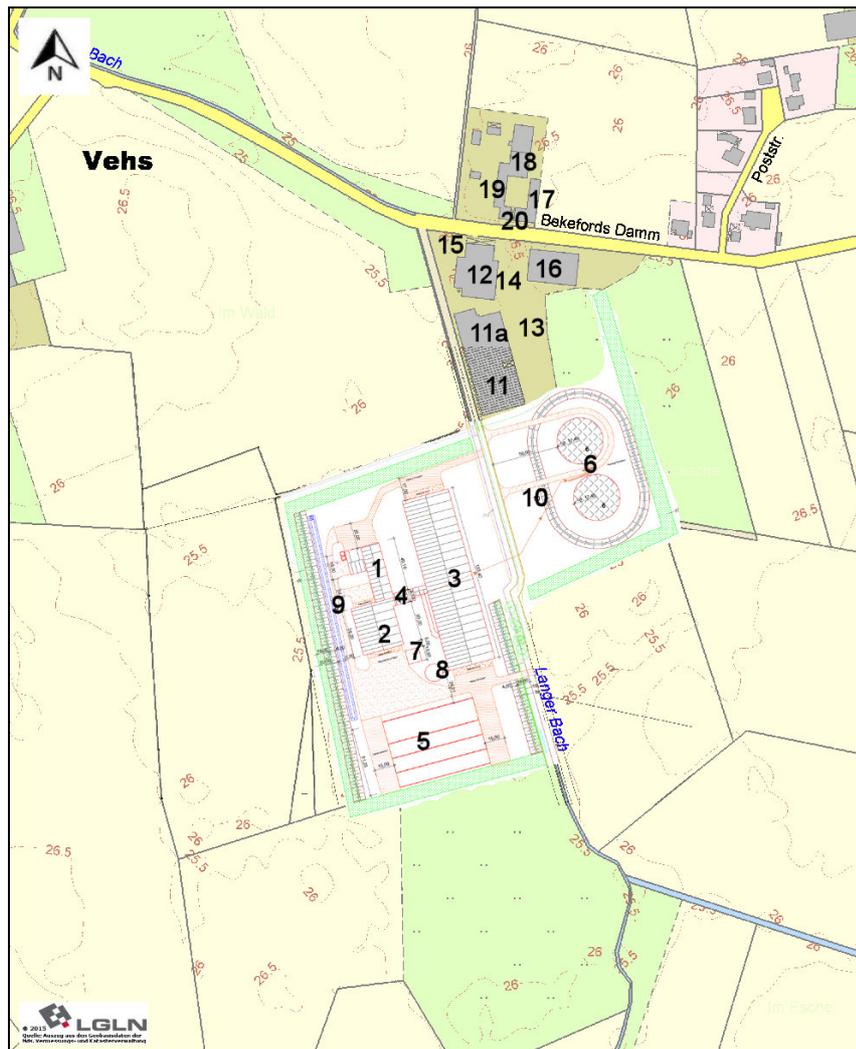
Lageplan des Betriebes Budke im Planzustand.
